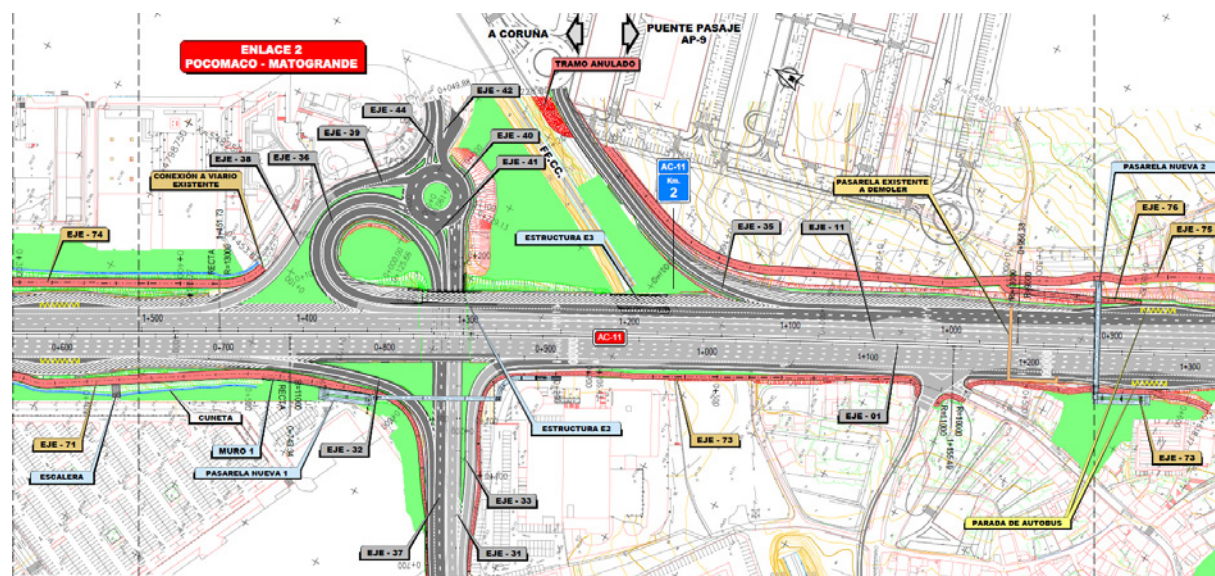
Planta general de las actuaciones propuestas en la autovía AC-11.
